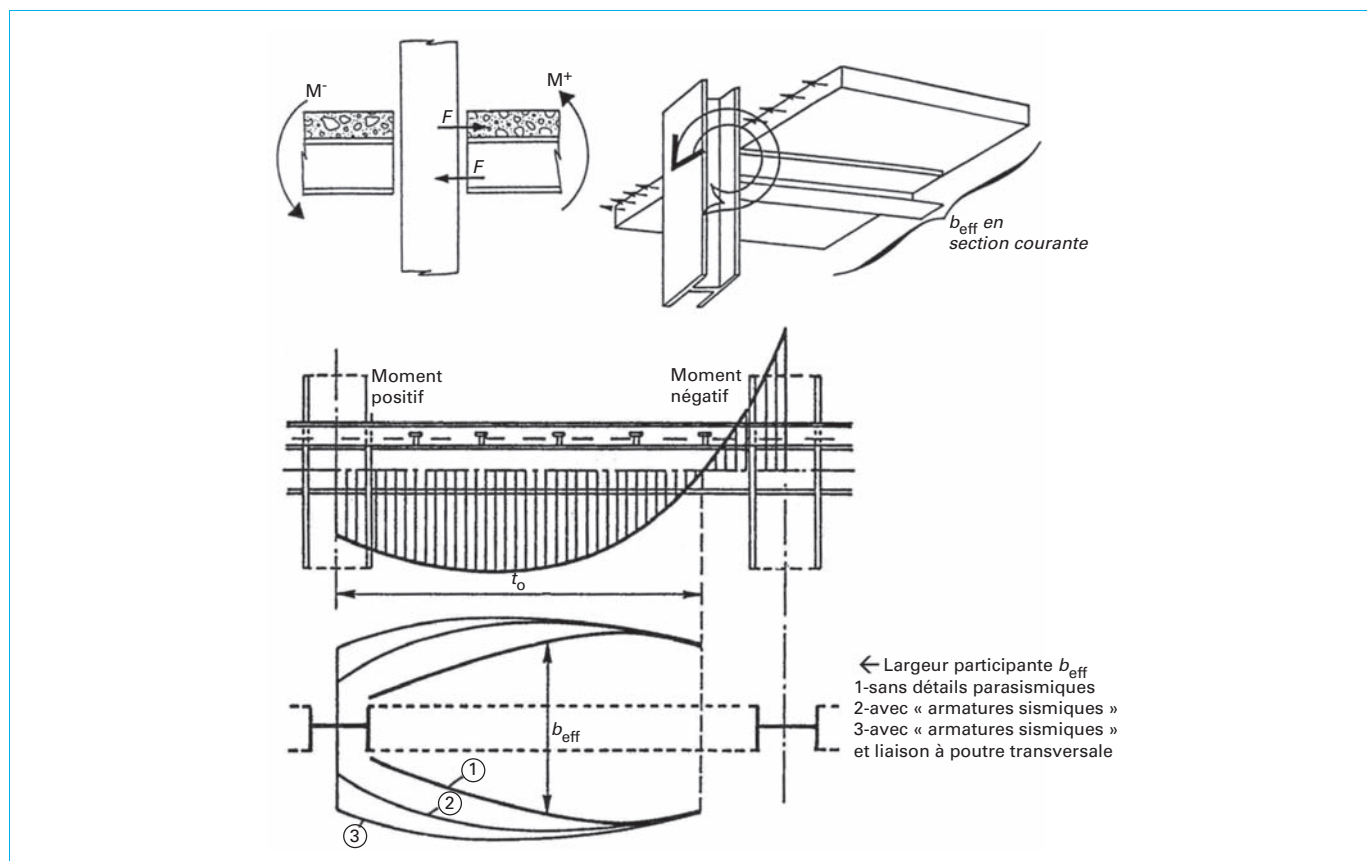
Définition d'une largeur participante au nœud poteau/poutre
